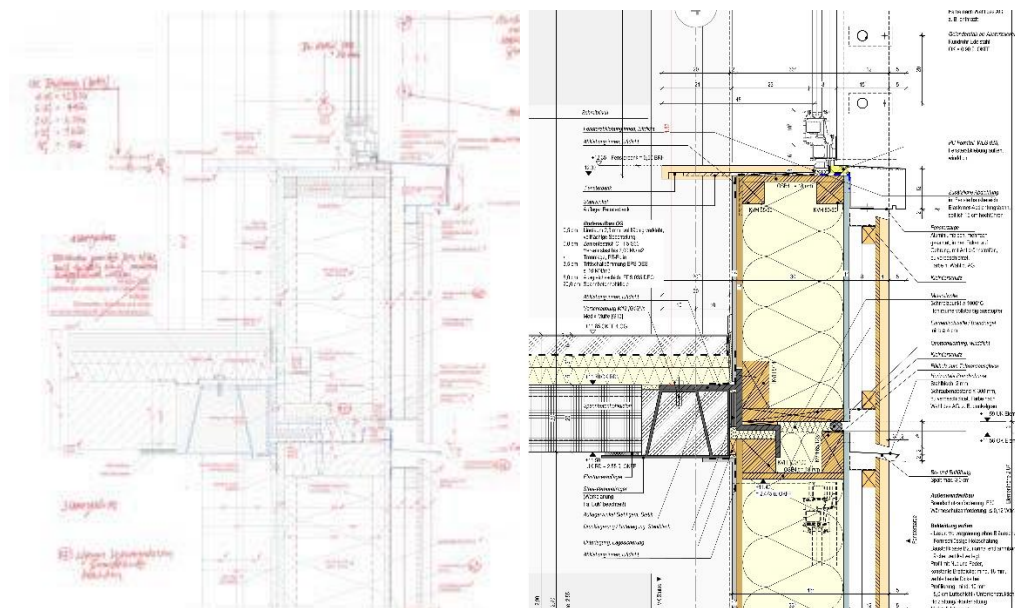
Detail Montageplanung vertikal oberer Anschluss, [Rubner Holzbau GmbH]
